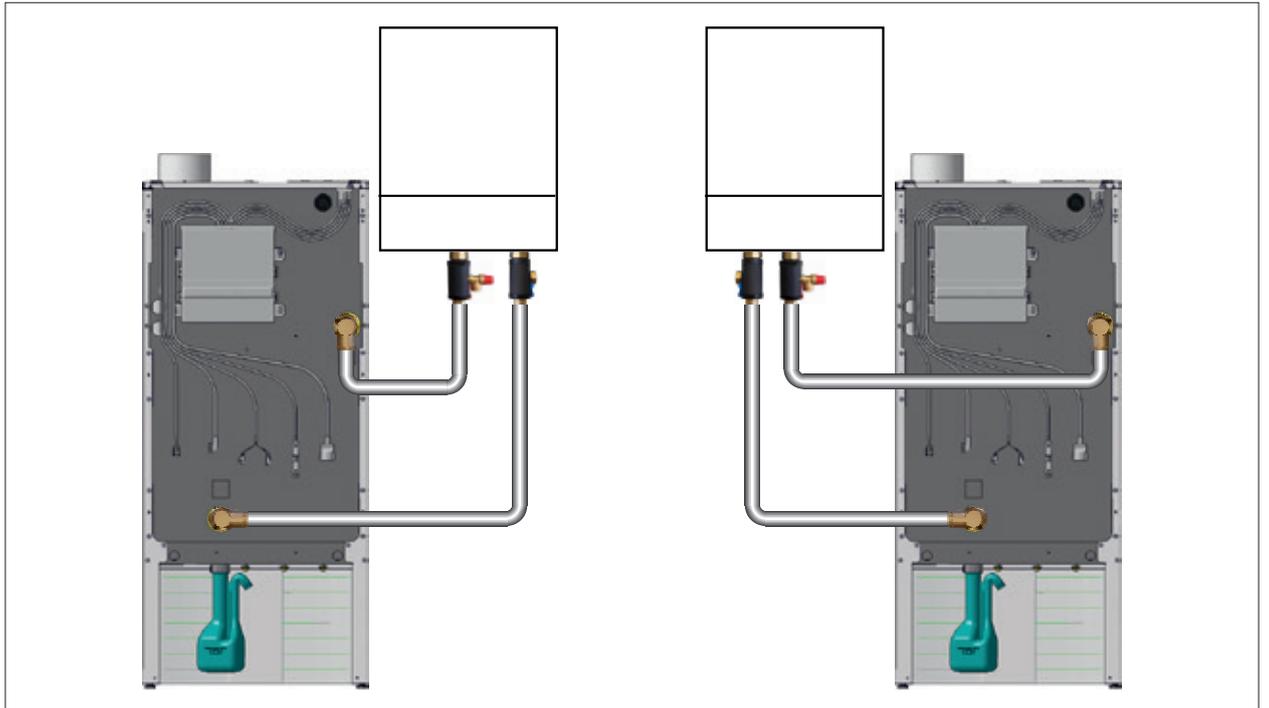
Kit di collegamento accanto alla caldaia sulla parete
